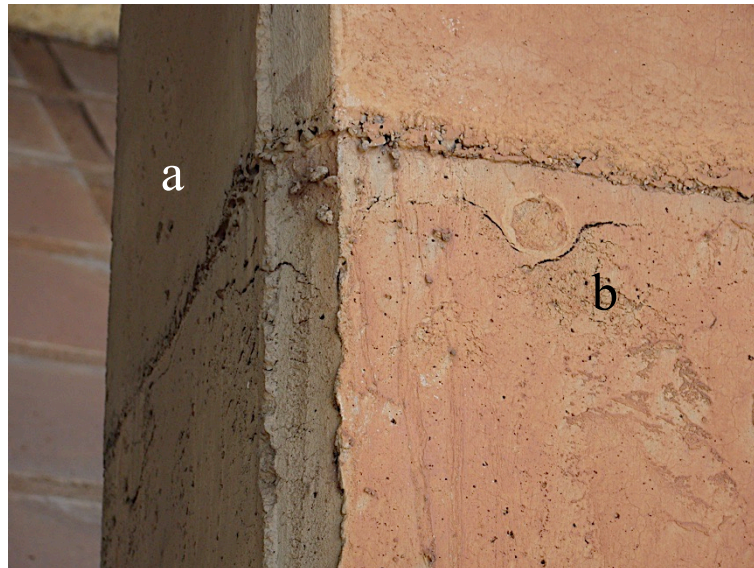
Detalhe da região onde foram encontrados os danos no pilar P1. (a) Falha de concretagem (perda de nata de cimento) e (b) fissura de assentamento plástico.
